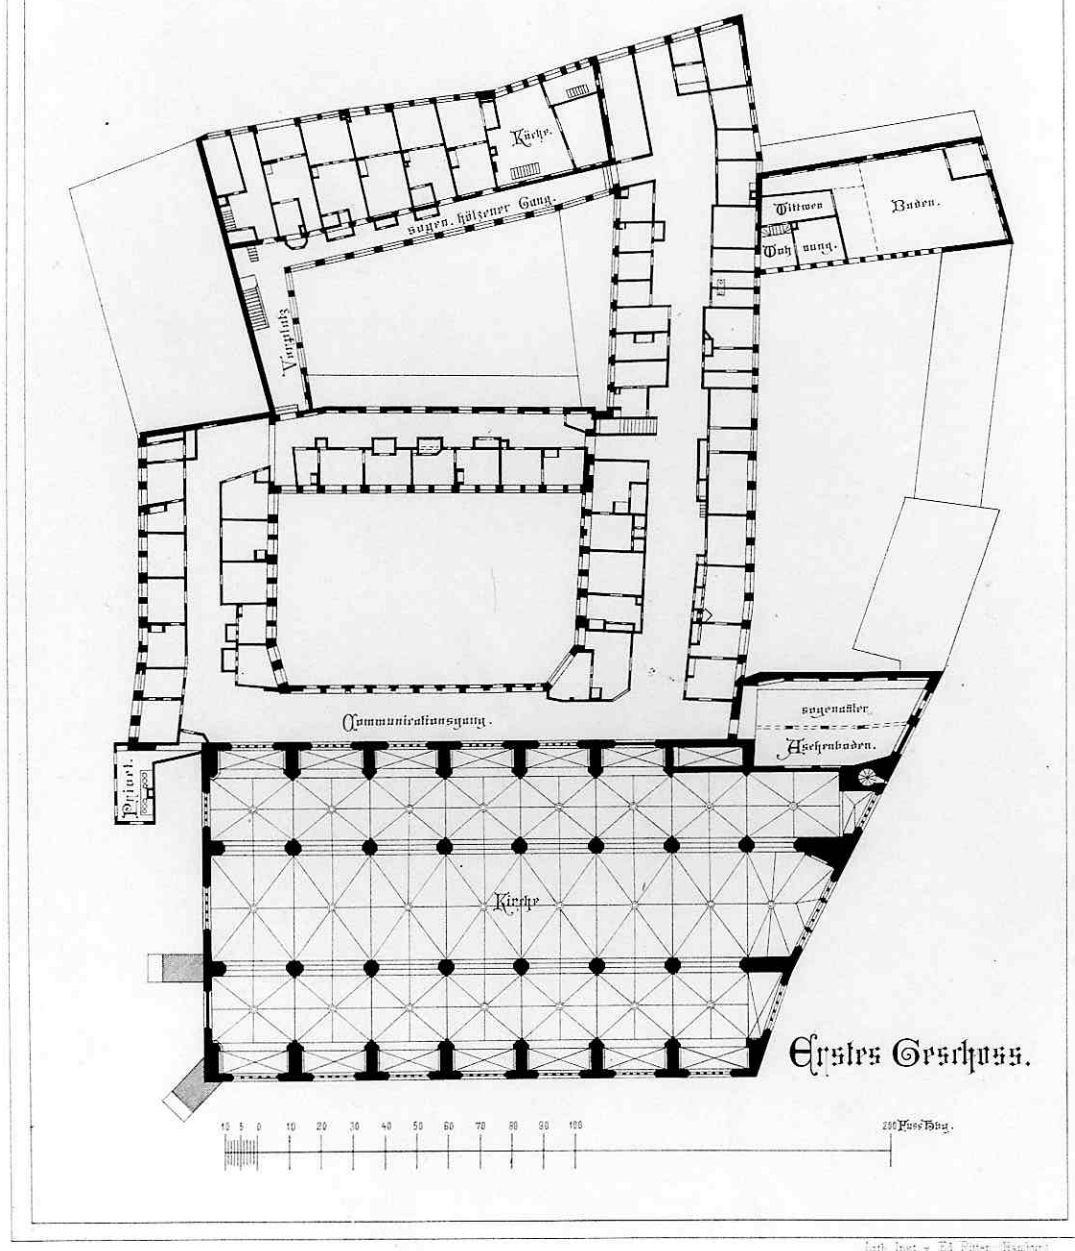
St. Johannis, Hamburg, Grundriss
